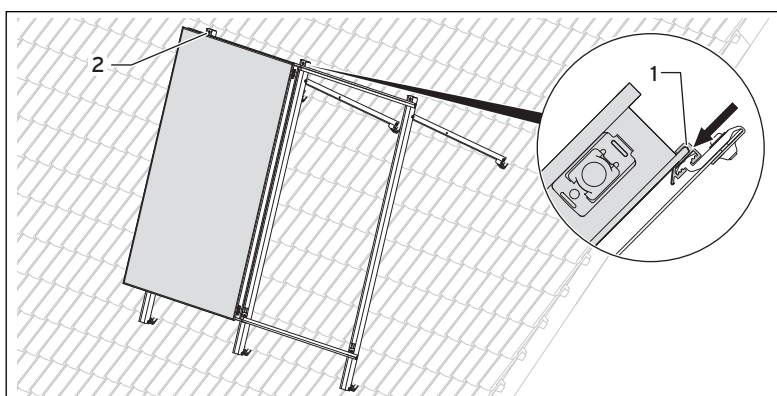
Fissaggio in alto del collettore piano VFK 135/2 VD
